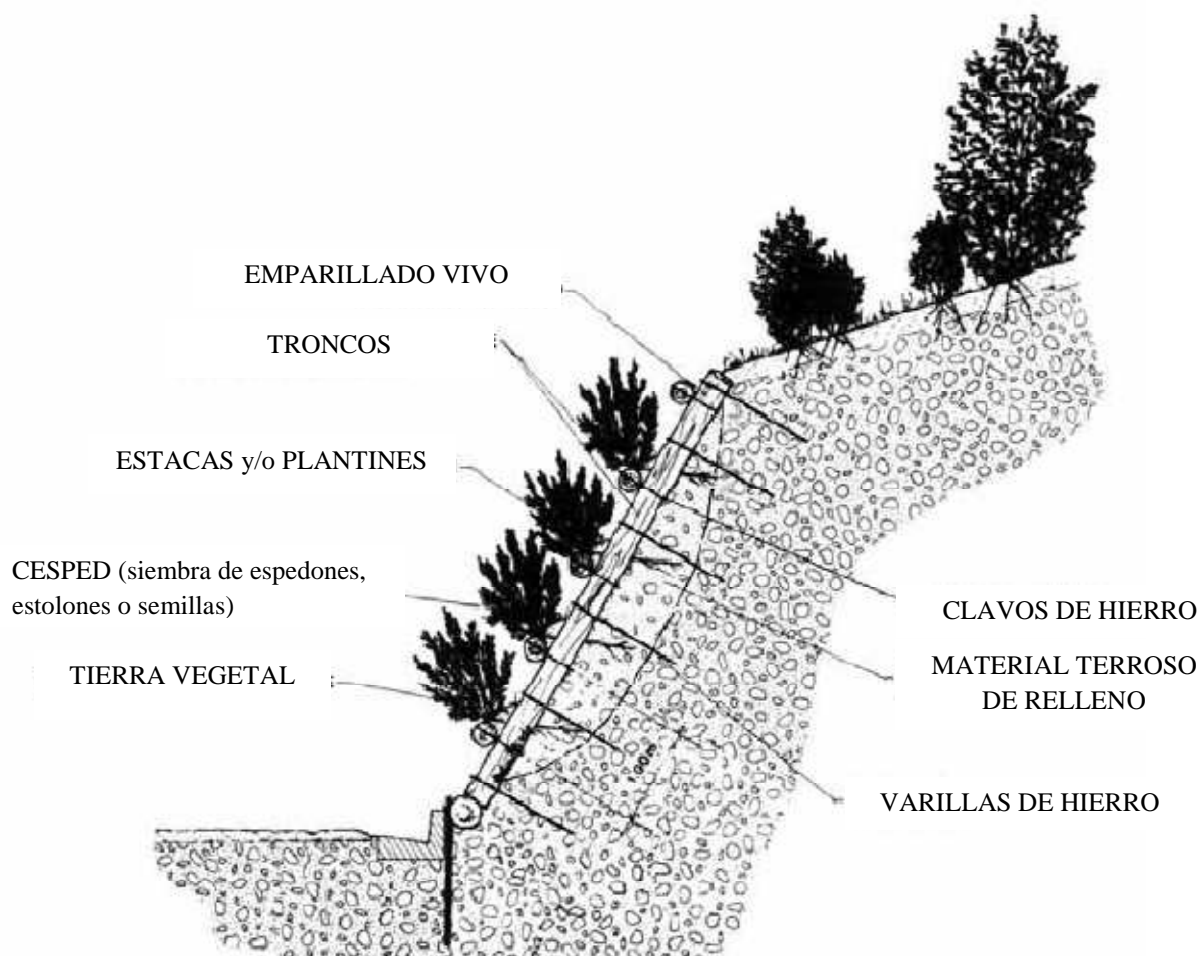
a - Emparillado vivo - Vista lateral (SAULI, CORNELINI, PRETI; 2006)
